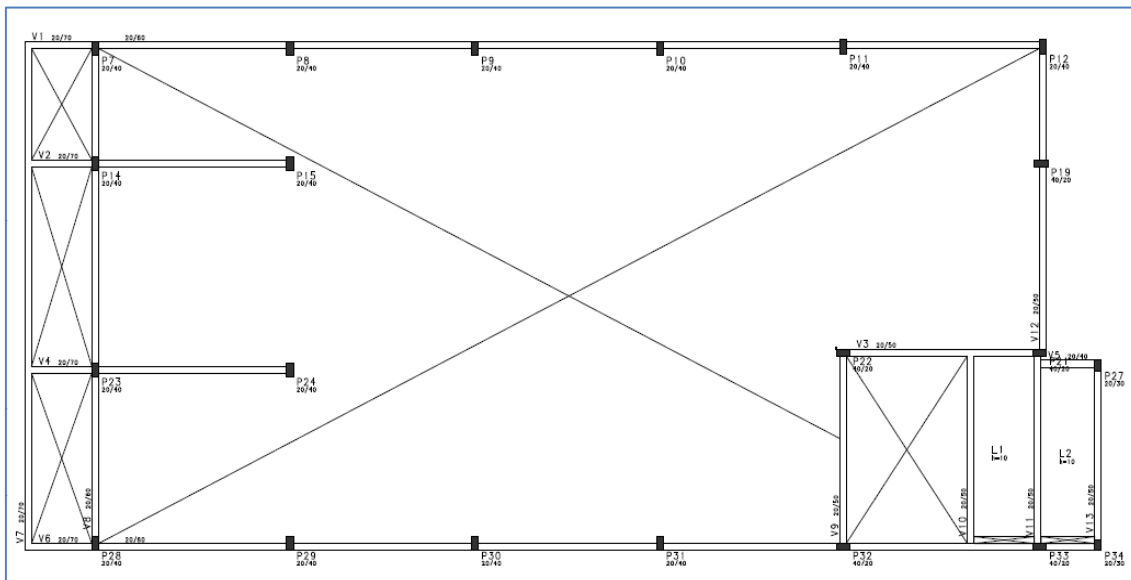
Planta de fôrma: cobertura, concreto armado (CAD/TQS).
